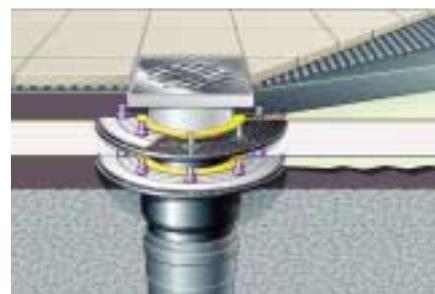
Bodenaufbau bei Bodenablauf mit Abdichtung durch zwei Dichtungsbahnen
